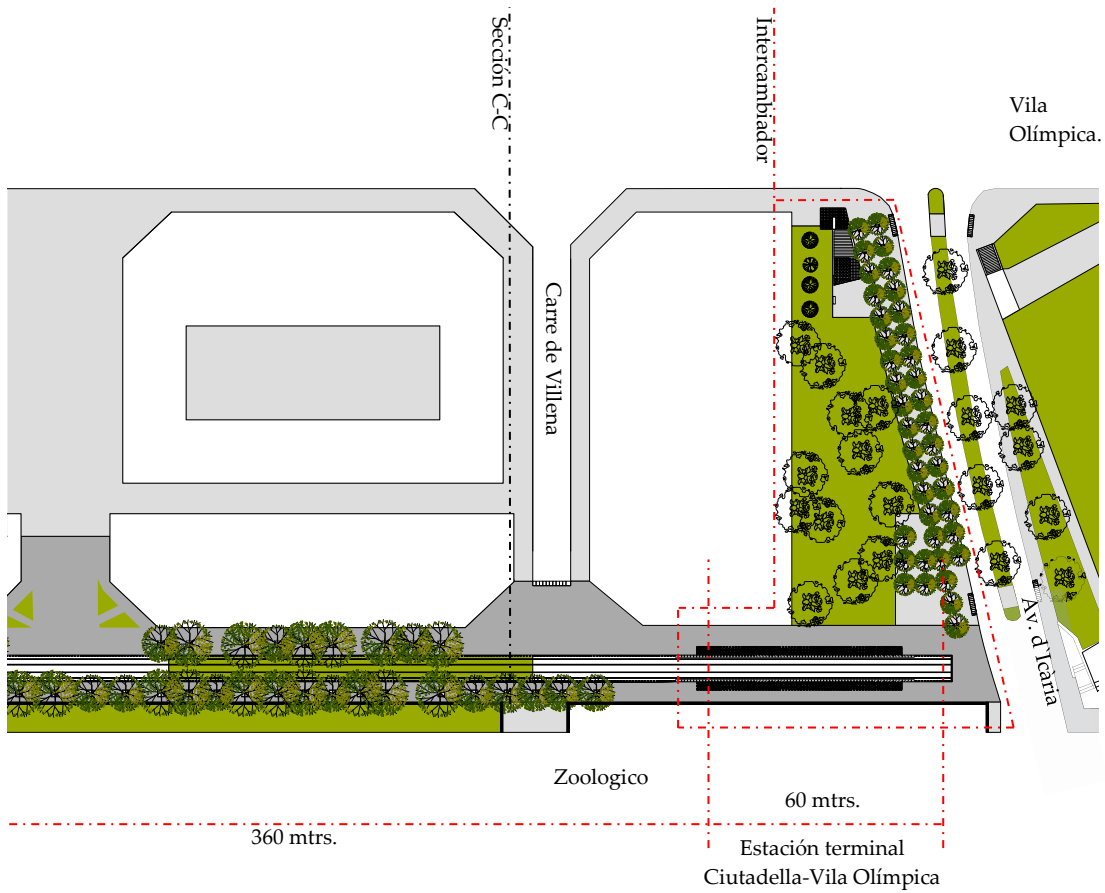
Planta calle Wellington. Fuente: elaboración propia.
